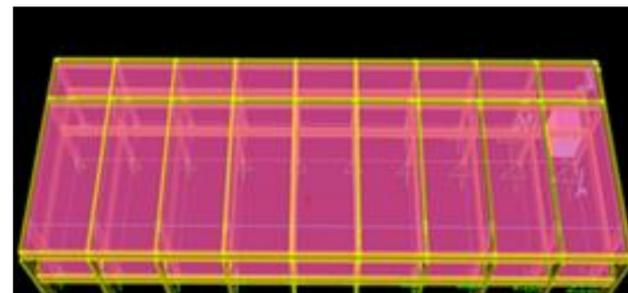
Vista de Tope de Estructura de Hormigón Armado
